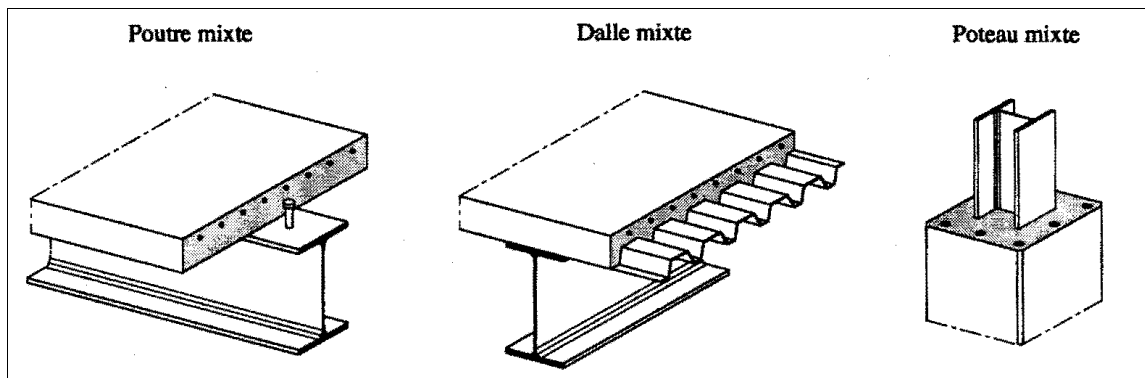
Exemples d'éléments mixtes (acier-béton)
